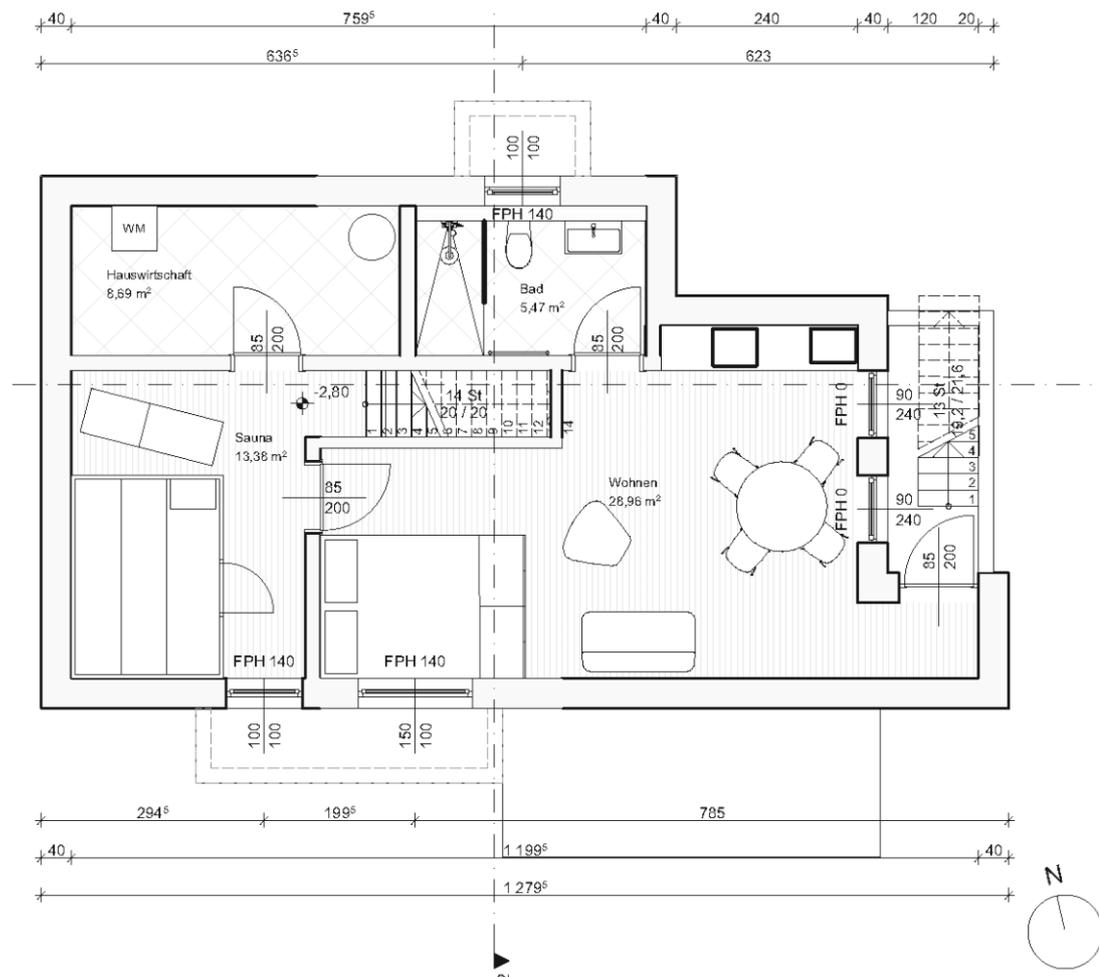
Grundriss Untergeschoß 1:100 (eigene Abbildung)
